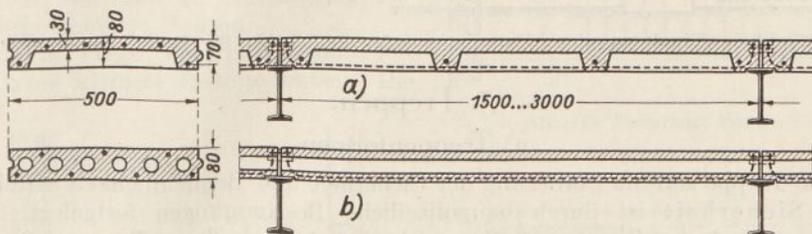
Kassettenplatte a) und Stegzementdielen b).
